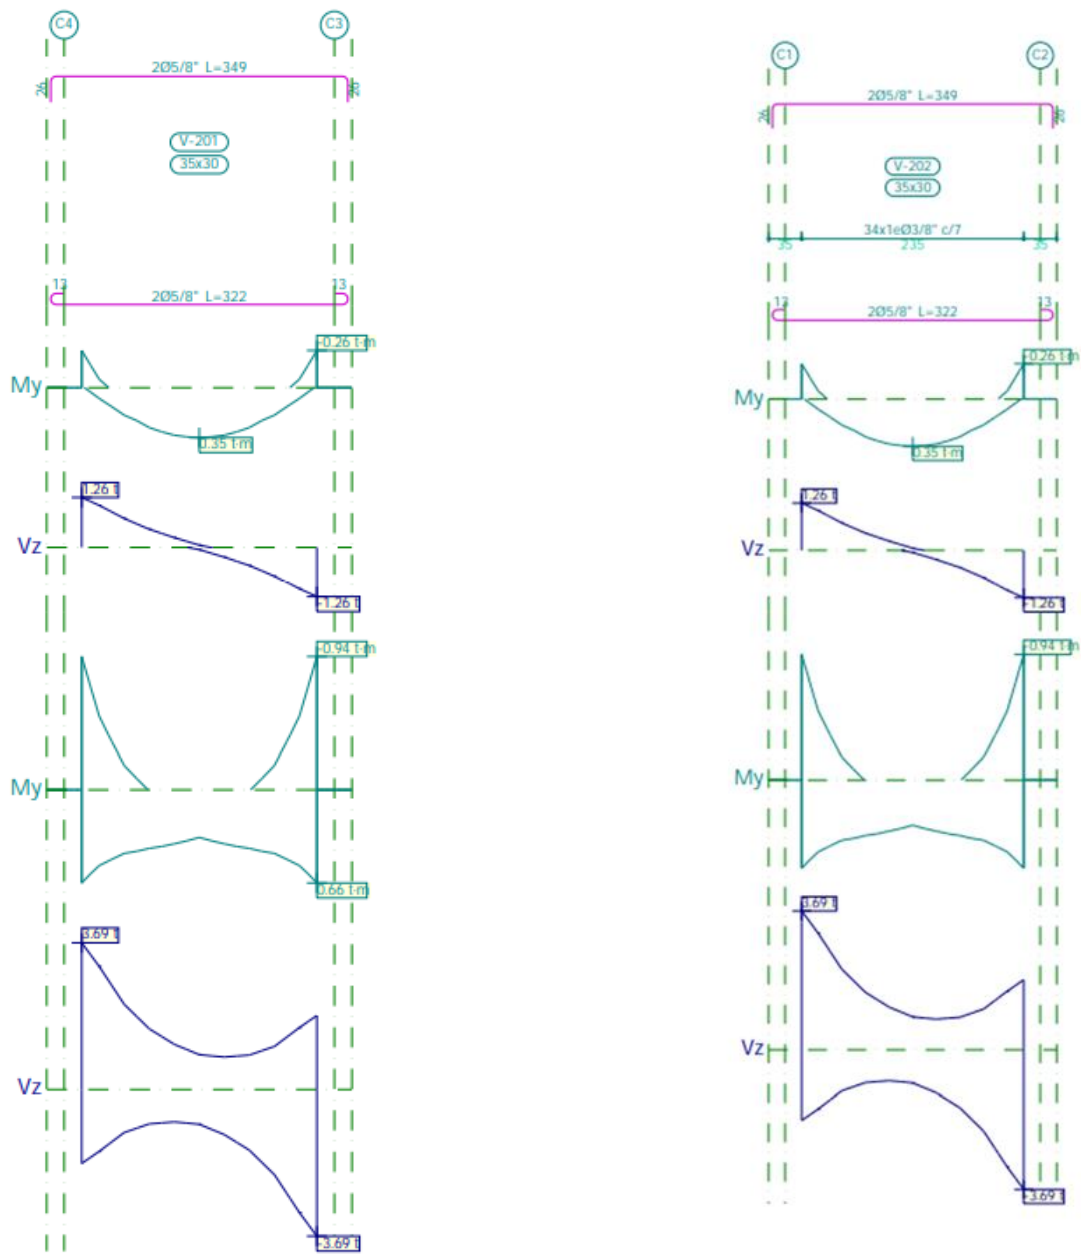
Sistema de pórtico para evaluar la estructura Pórtico 1 y Pórtico 2
